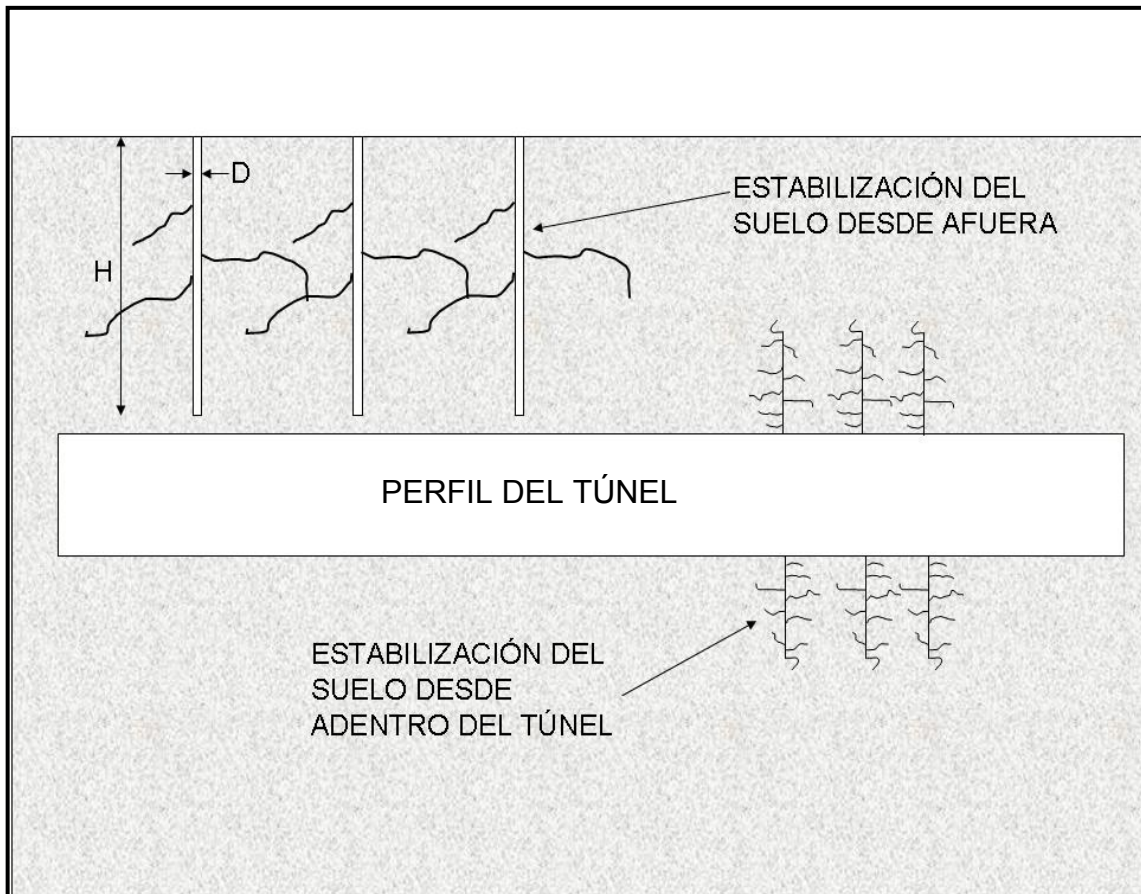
“EXCAVACION DE POZOS Y TÚNELES”
